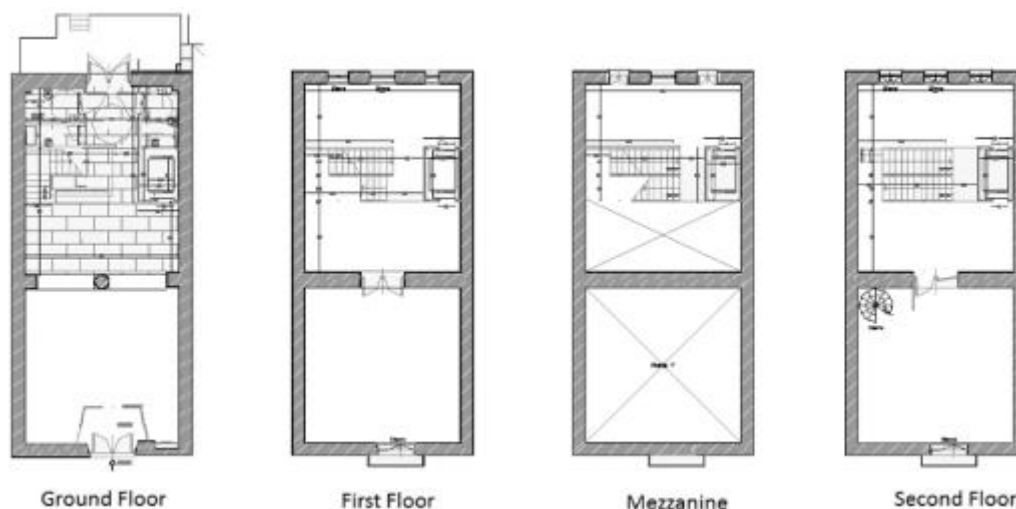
VISTA DE PLANTA DE KAPITAIN ETXEA
